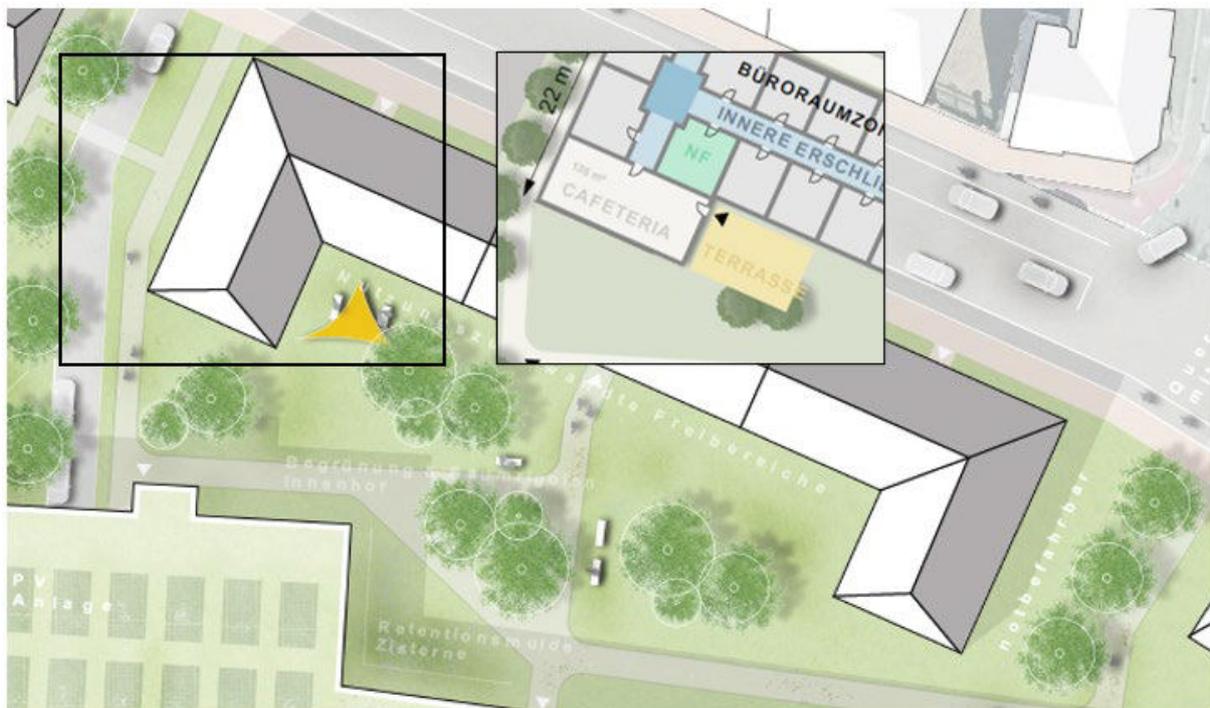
Ausschnitt Lageplan und Funktionsgrundriss – Nutzungszugewandte Freibereiche (o.M.)
